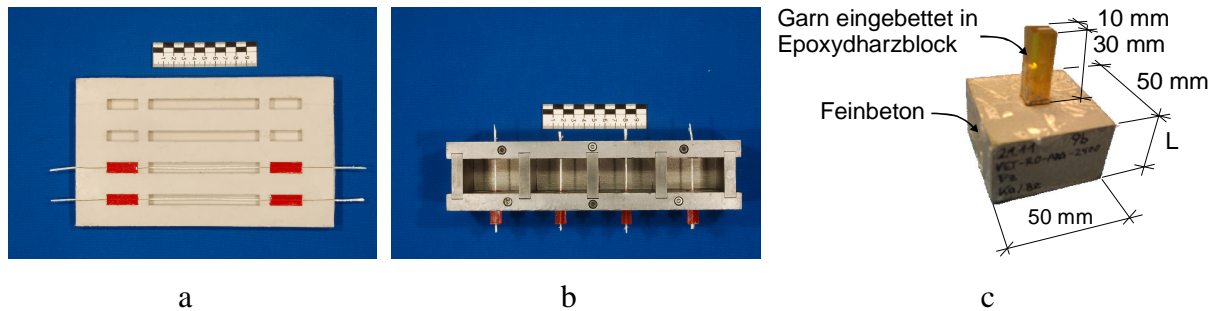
a) Epoxydharzeinbettung, b) Betonschalung, c) Garnauszugprobekörper
